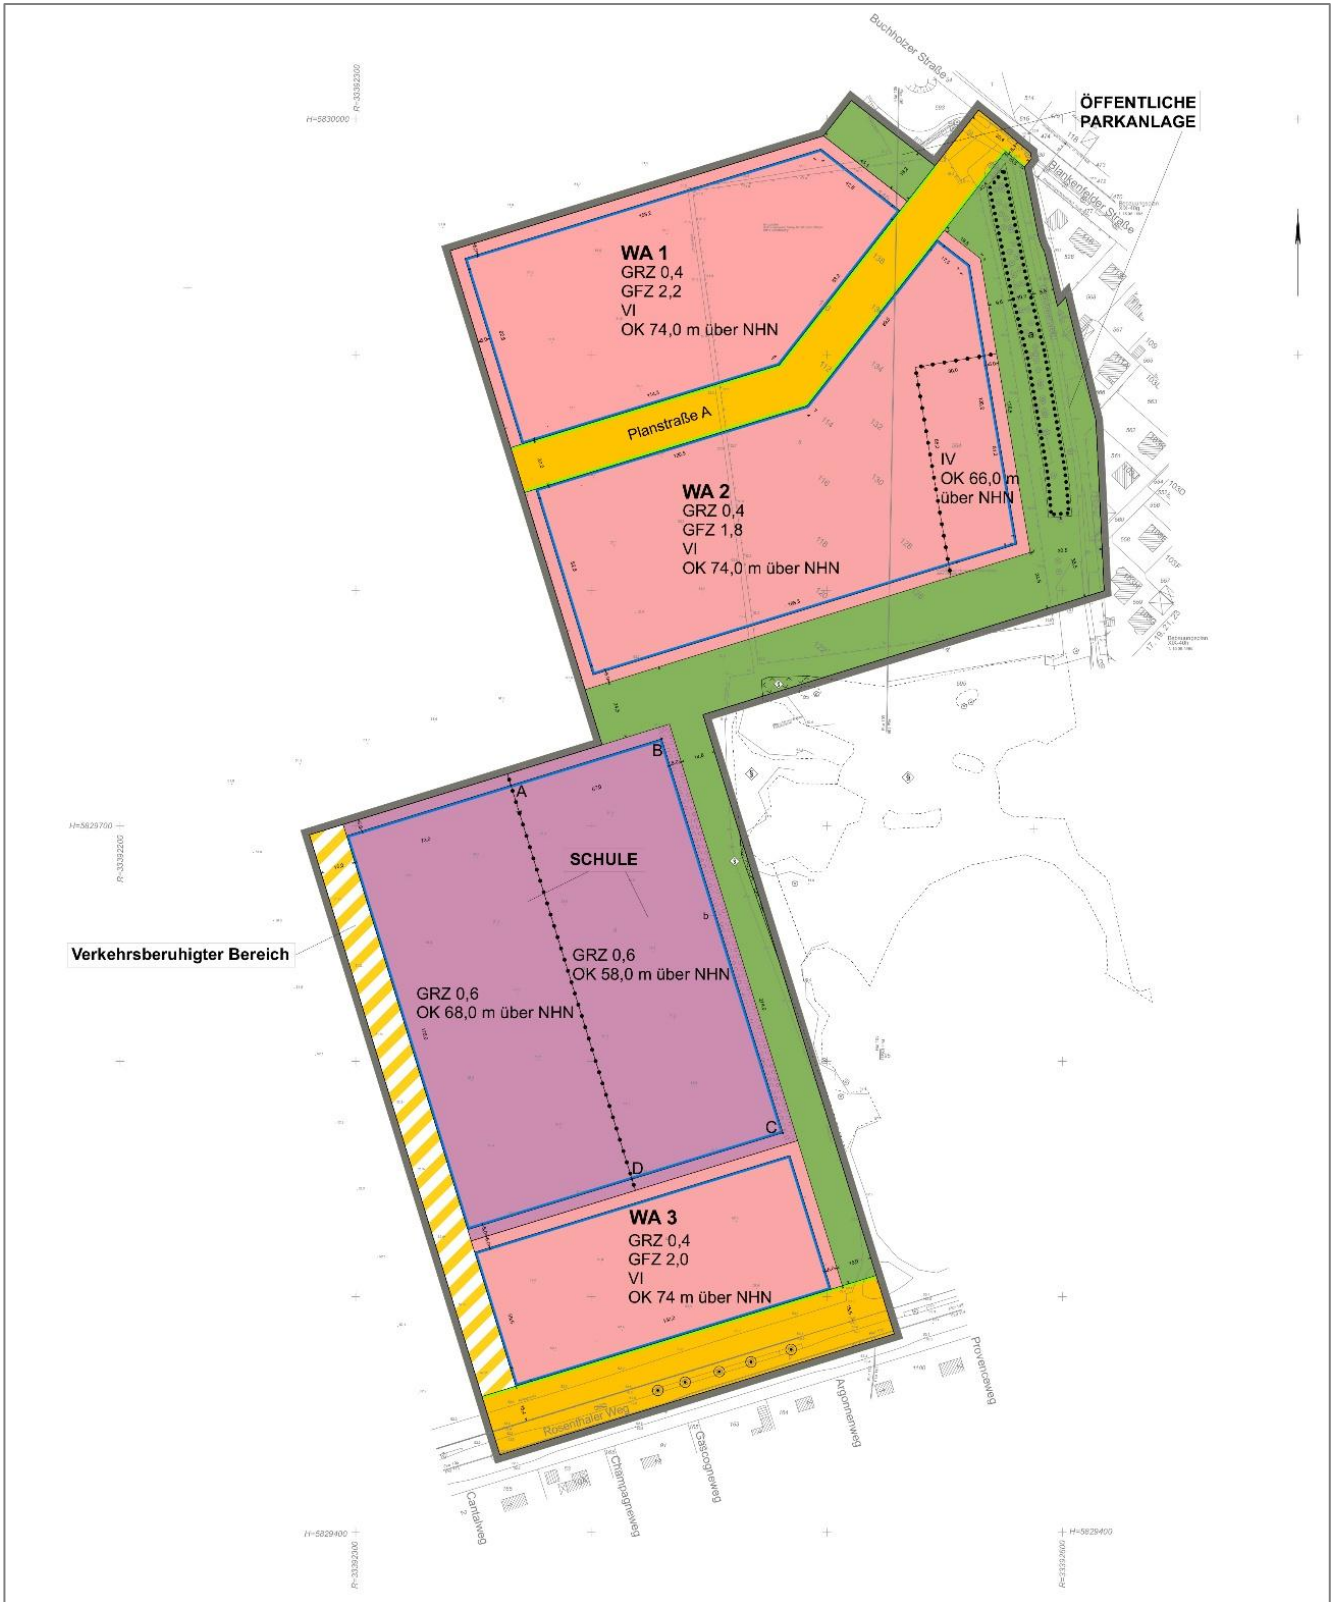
Eingriffsbereich, Ausschnitt aus der Planzeichnung des B-Plans 3-89 zum Stand 10.2025 (SenStadtBW 2025), zum Zeitpunkt der Berichterstellung noch nicht rechtsverbindlich.
